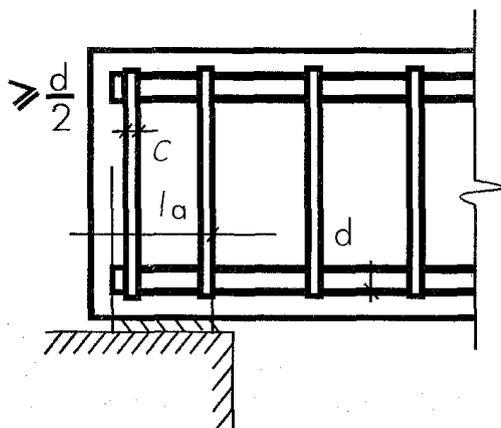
Анкеровка продольных стержней на свободных опорах
